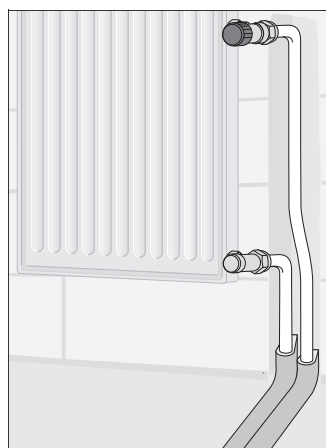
Radiador compacto con enlaces de compresión RAUMULTI press
